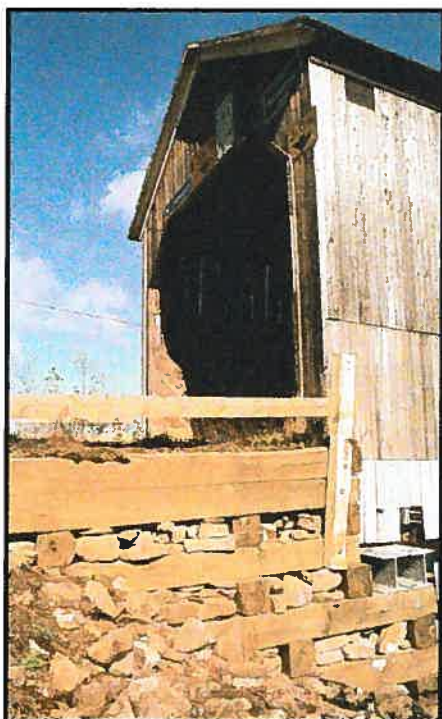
Le pont Mangrum (55-02-10) dont les culées sont construites en caisson de bois empierré.
